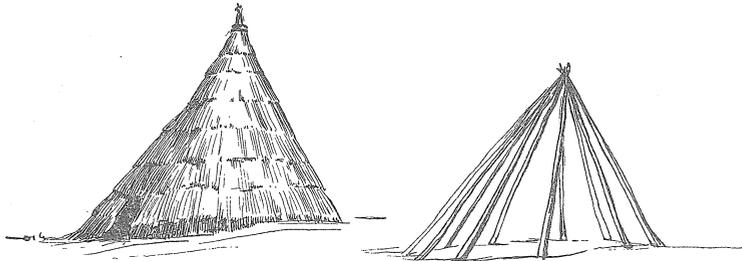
Casa e pormenor de construção das cabanas de Prime (Fragozela, Viseu).
